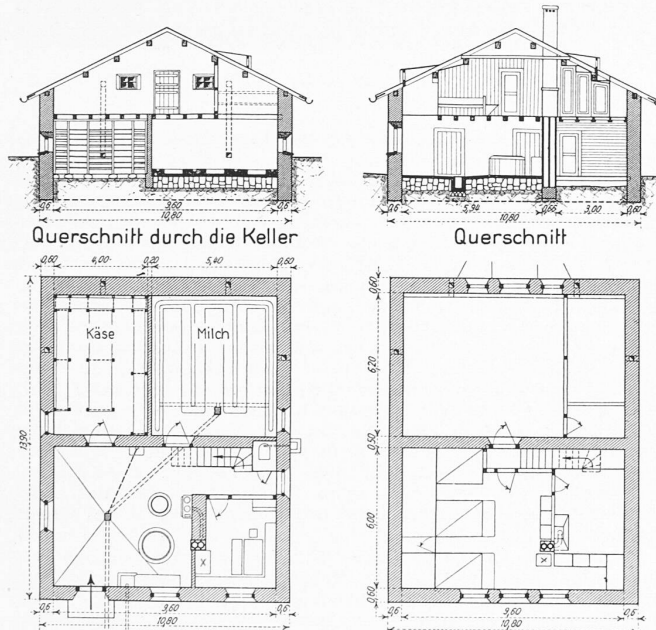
Bessere Sennhütte. Grundrisse und Schnitte 1:300
